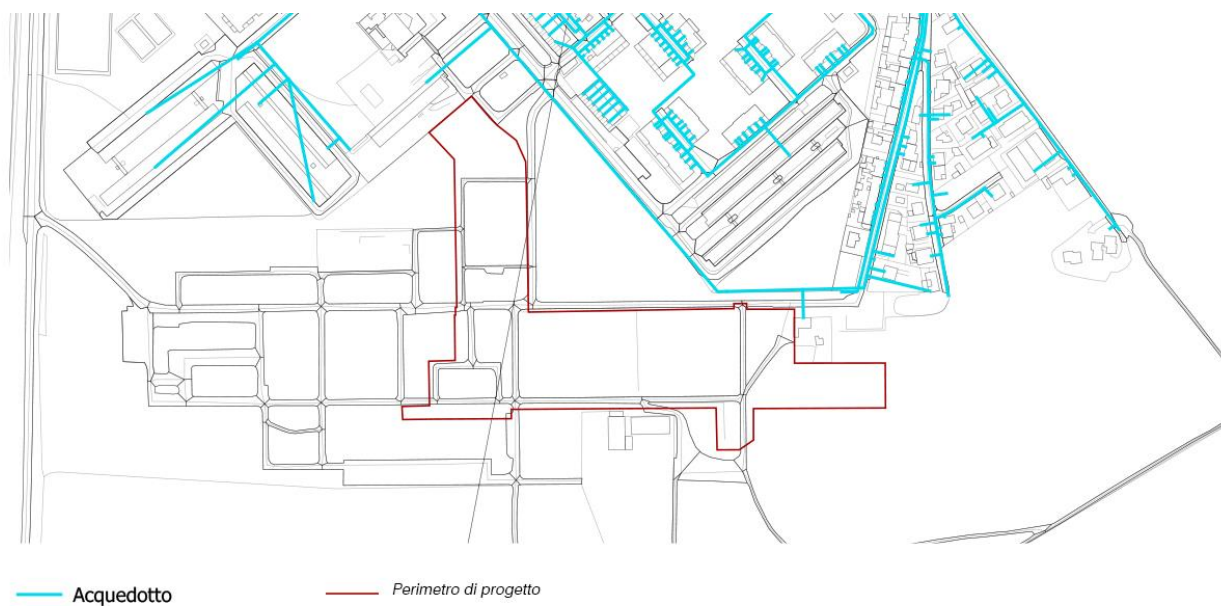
Planimetria dell'acquedotto esistente fornita da ASET
